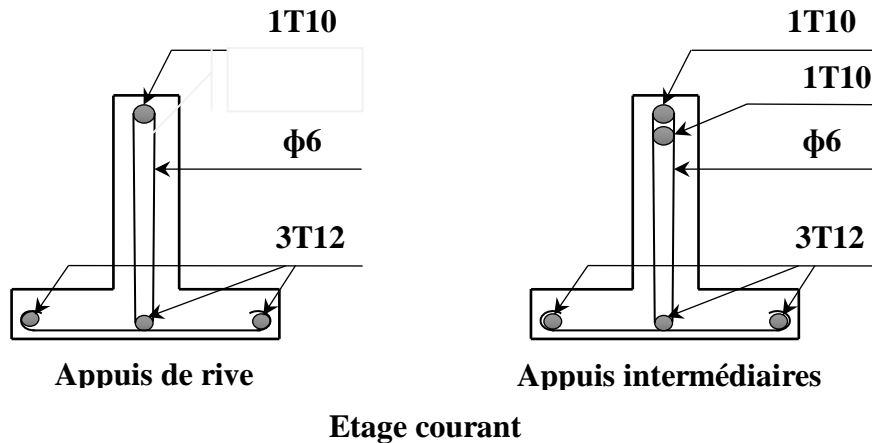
Dessin de ferrailage des poutrelles (étage courant).
